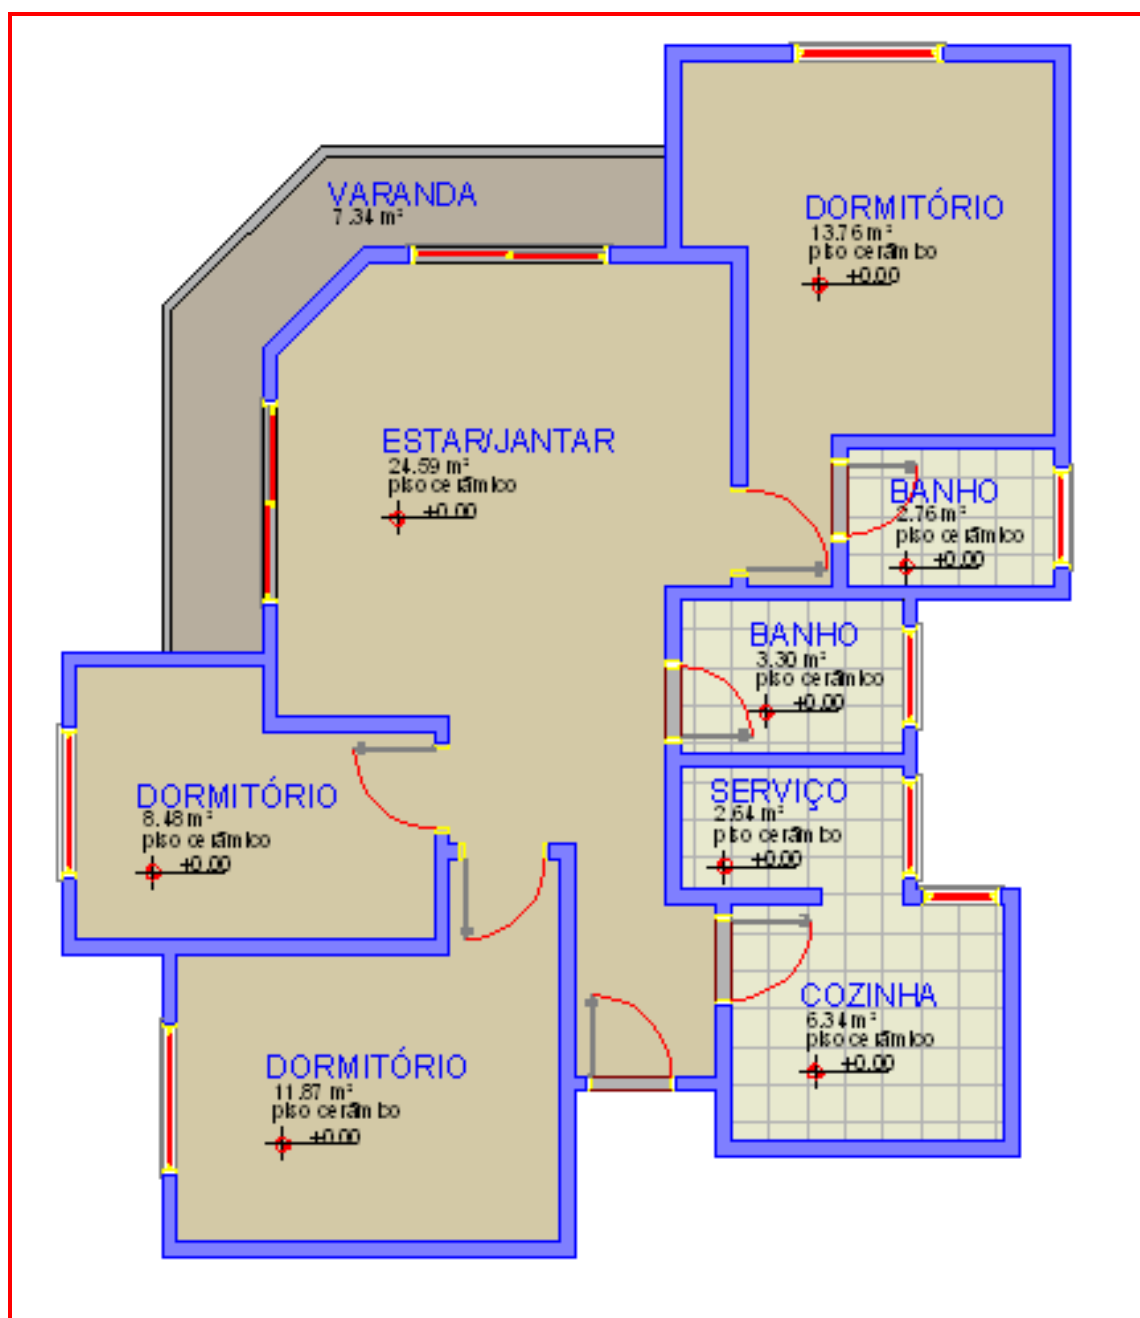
Planta do apartamento modelo com 81,08 m², sem escala.
